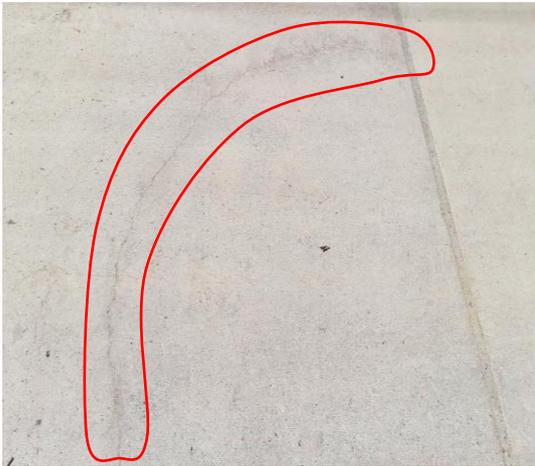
Falla – grieta transversal con severidad baja y media.
